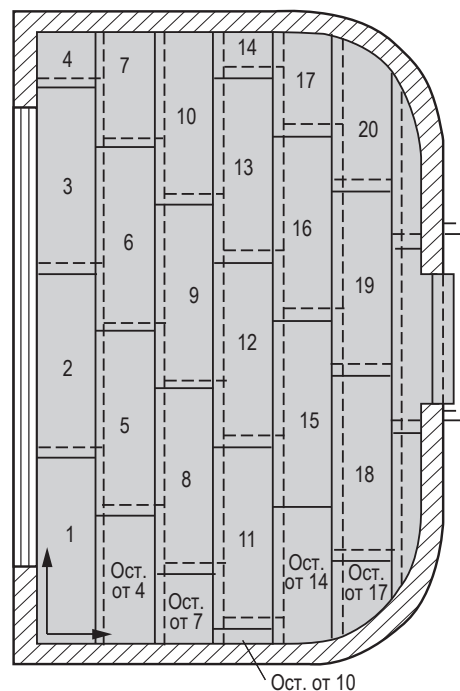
Укладка элементов пола от стены, противоположной стене с дверным проемом.
